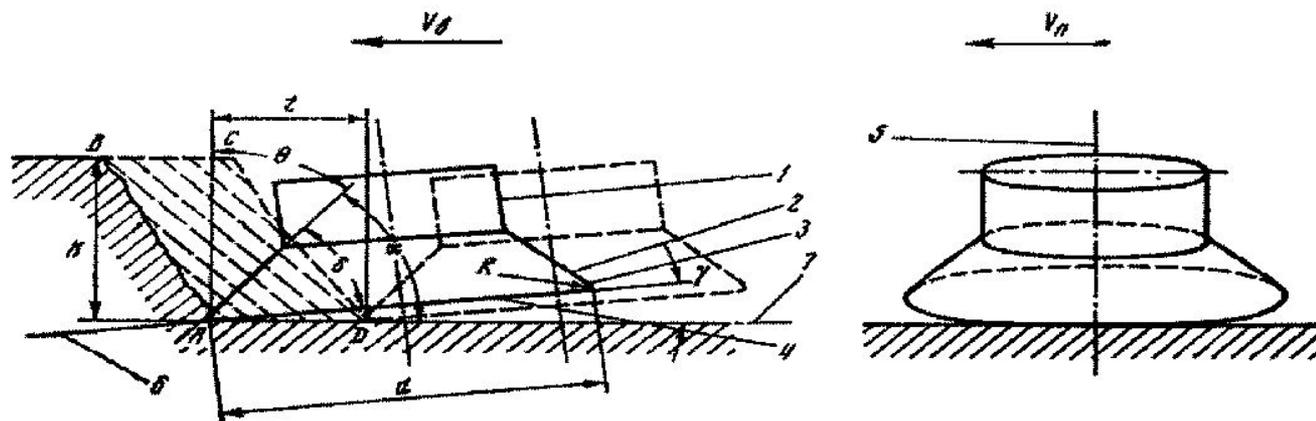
Схема отбойки породы дисковой шарошкой тангенциального действия: 1 — корпус шарошки; 2 — боковая поверхность шарошки; 3 — рабочая кромка шарошки; 4 — торцевая поверхность шарошки; 5 — ось вращения шарошки; б — нормальная секущая плоскость; 7 — плоскость разрушения; V_b — скорость боковой подачи шарошки; V_n — скорость перекатывания шарошки; d — диаметр шарошки; R — радиус закругления рабочей кромки шарошки; t — шаг разрушения; H — толщина слоя породы, снимаемого за один проход шарошки; $ABCD$ — поперечное сечение слоя породы, снимаемого за один проход шарошки; α — угол резания; δ — угол заострения шарошки; θ — передний угол; γ — задний угол
